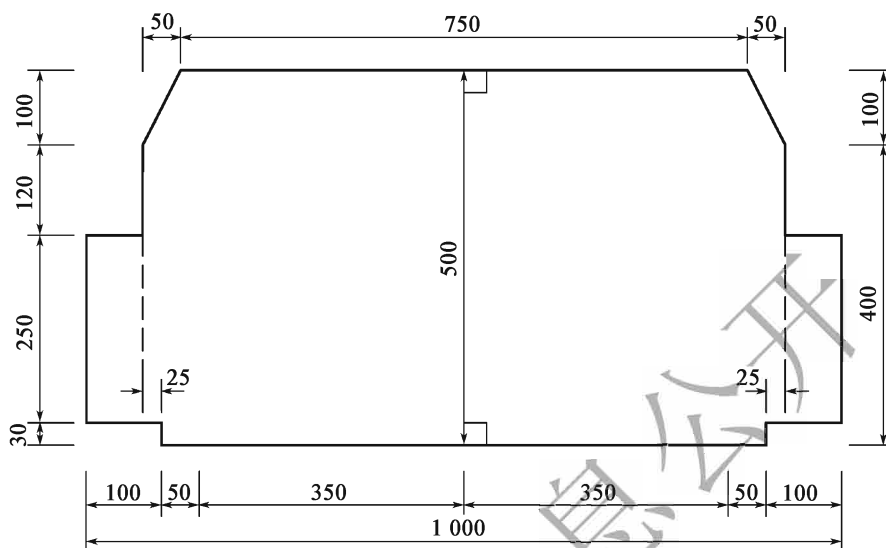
Dégagement de construction du tunnel routier de deuxième classe à deux voies (60km/h) (unité:cm)
